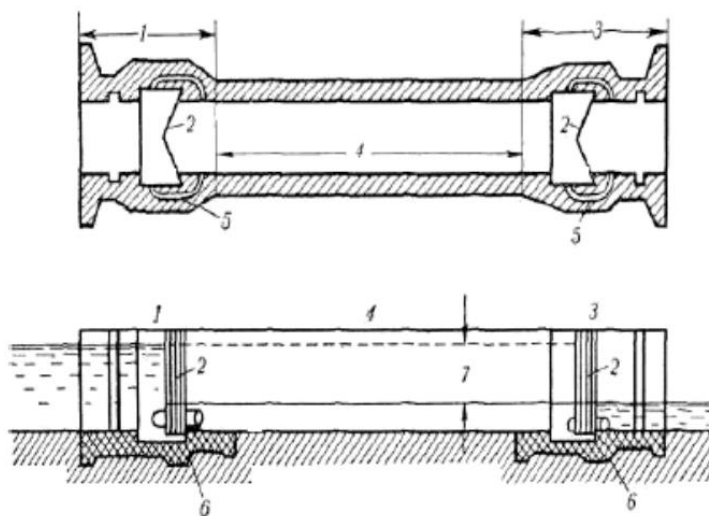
Конструкція судноплавнокамерного шлюзу:
